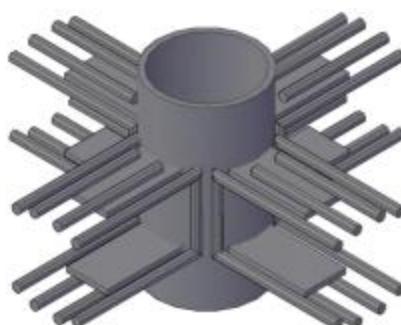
Вузол з'єднання монолітного безкапітельного безбалкового перекриття з трубобетонними колонами
